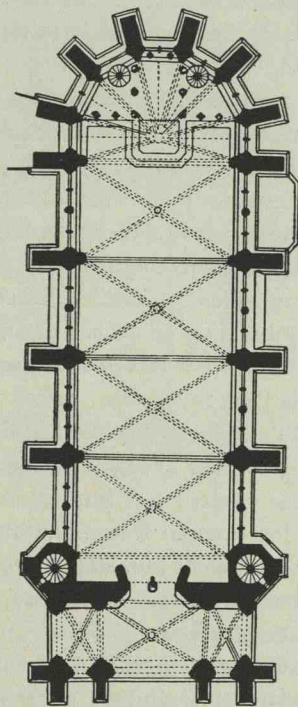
Plan de la chapelle haute de la Ste-Chapelle, Paris.
